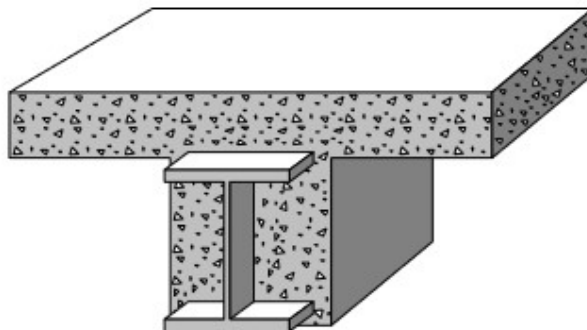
Enclausramento em concreto da viga de aço (RIBEIRO, 2004).
